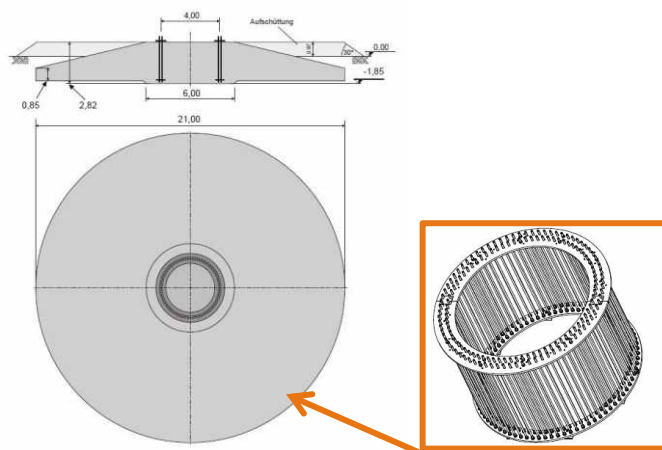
Schéma indicatif d'une fondation type et de sa cage d'ancrage
